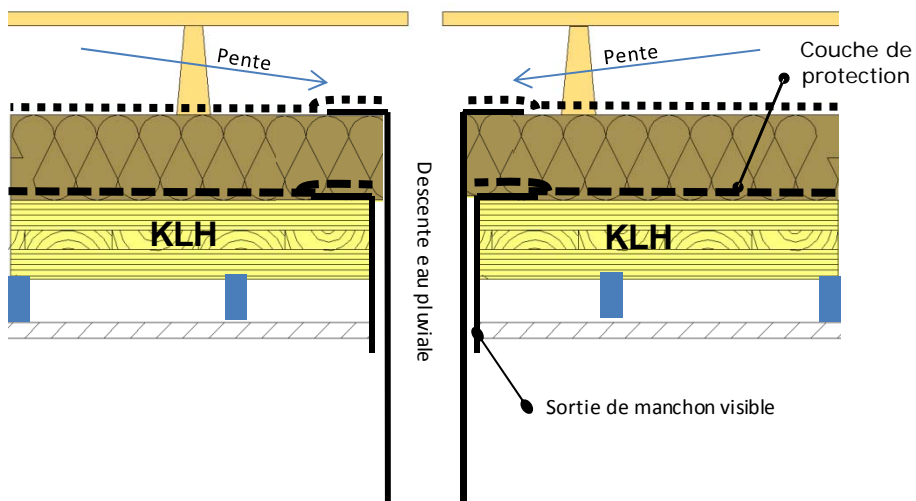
Descente des eaux pluviales en terrasses accessibles aux piétons et au séjour
